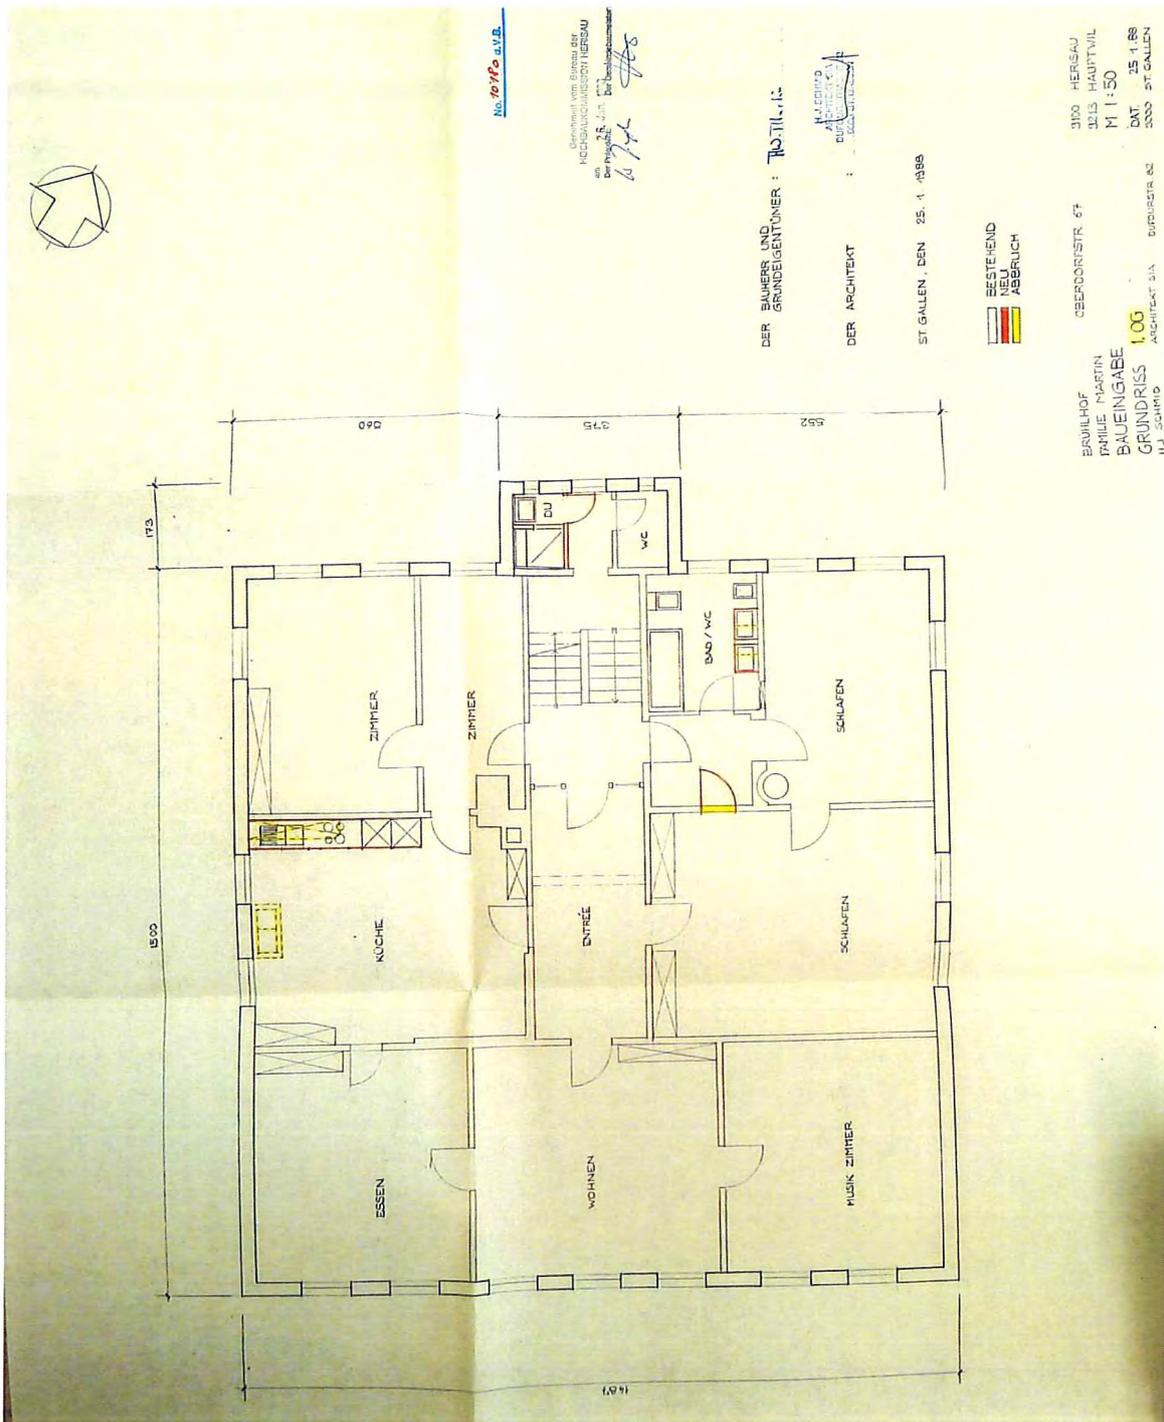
Baueingabe „Sanierung Wohnhaus“ Nr. 10'180 1988, zur Parzelle 523. Baueingabearchiv Gemeinde Herisau. Grundriss 1. Obergeschoss.
